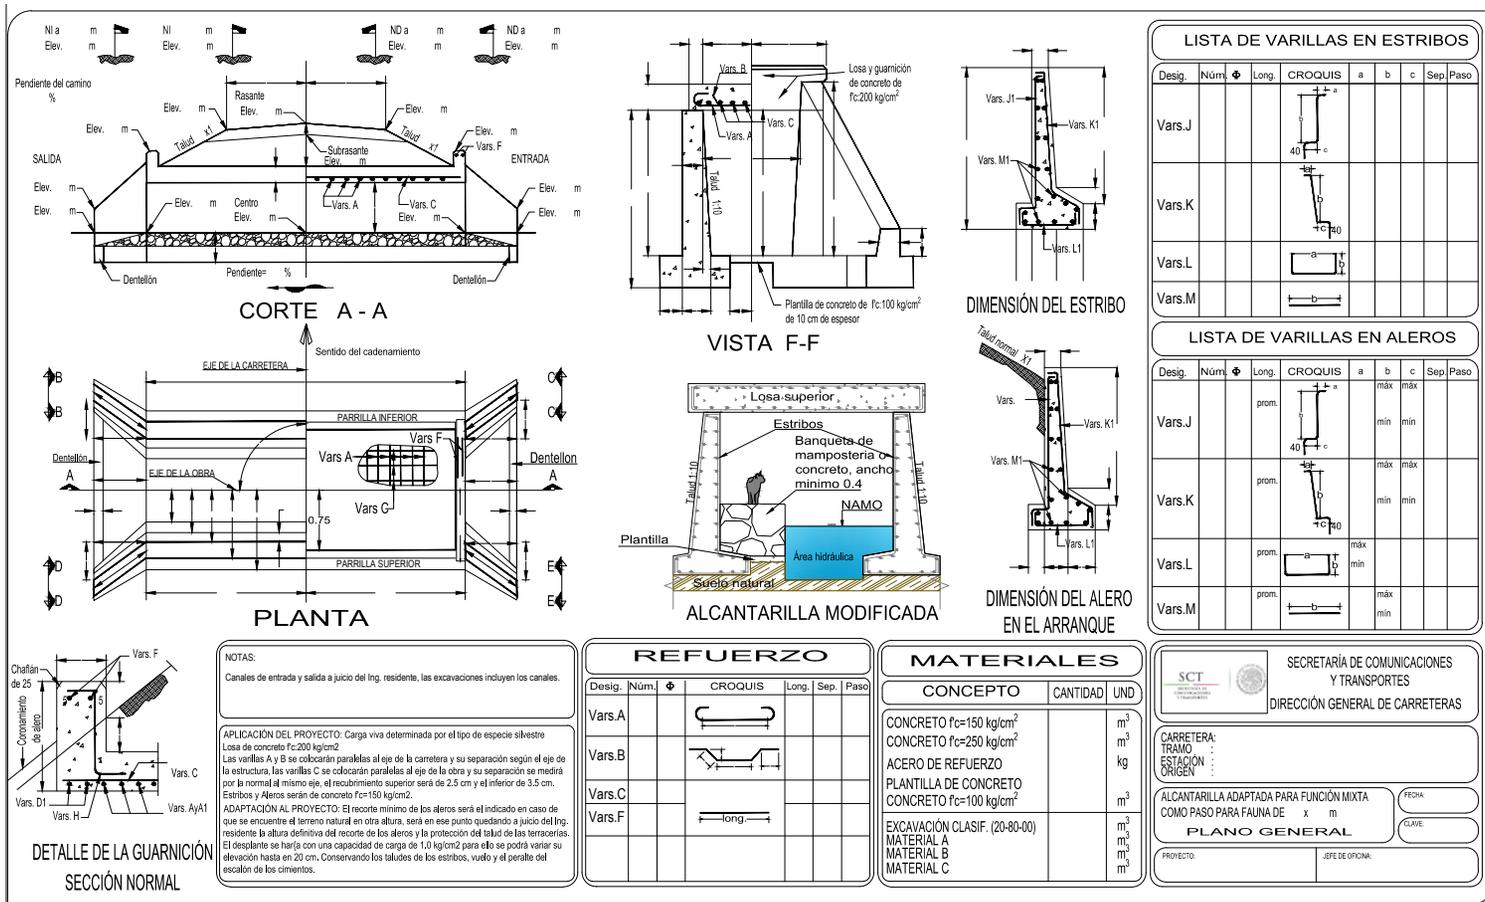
Planta y elevación de una alcantarilla de losa de concreto modificada para función mixta
